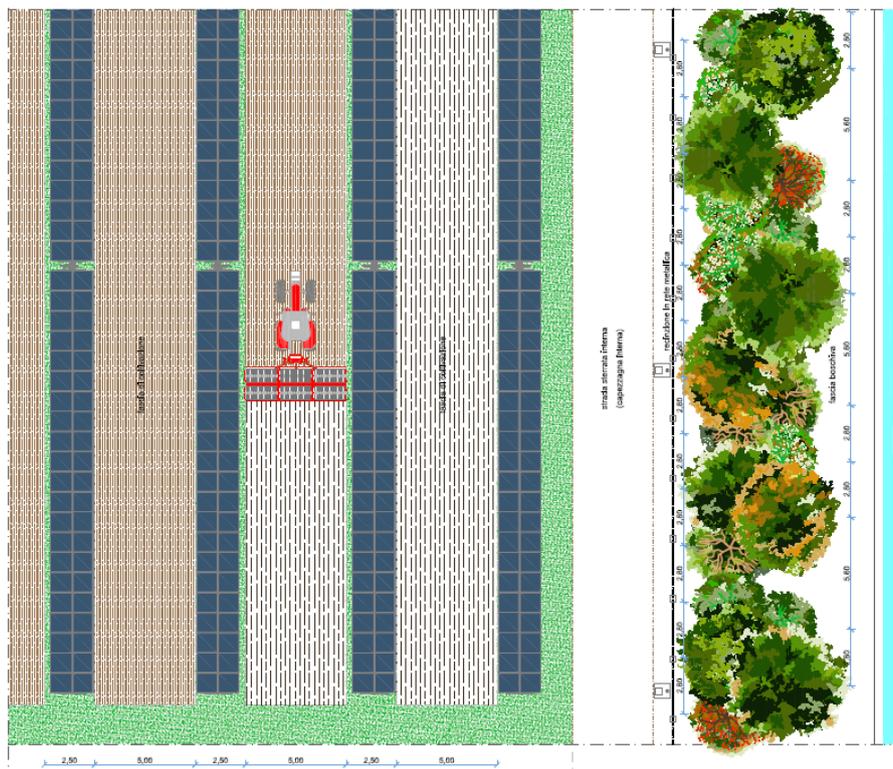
Fasce di coltivazione con i pannelli inclinati in direzioni diverse. Pianta – Stralcio
